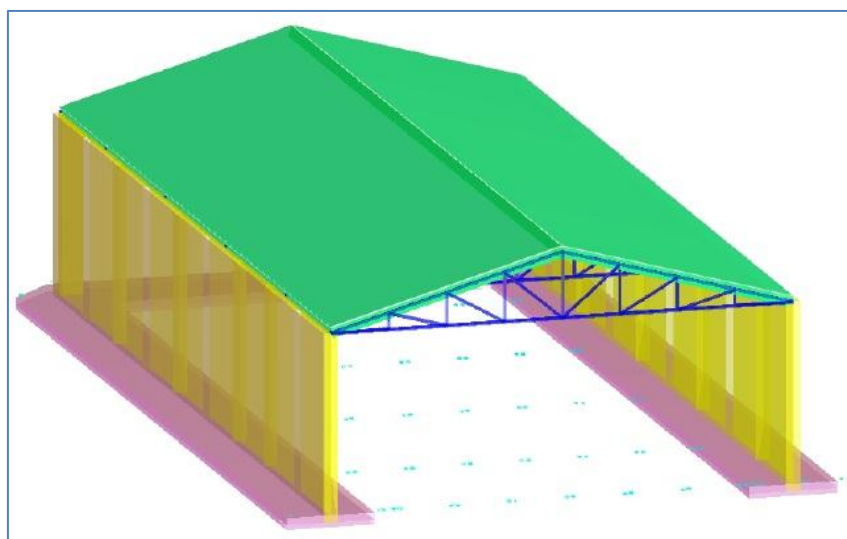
Vista assometrica della struttura nella sua interezza
